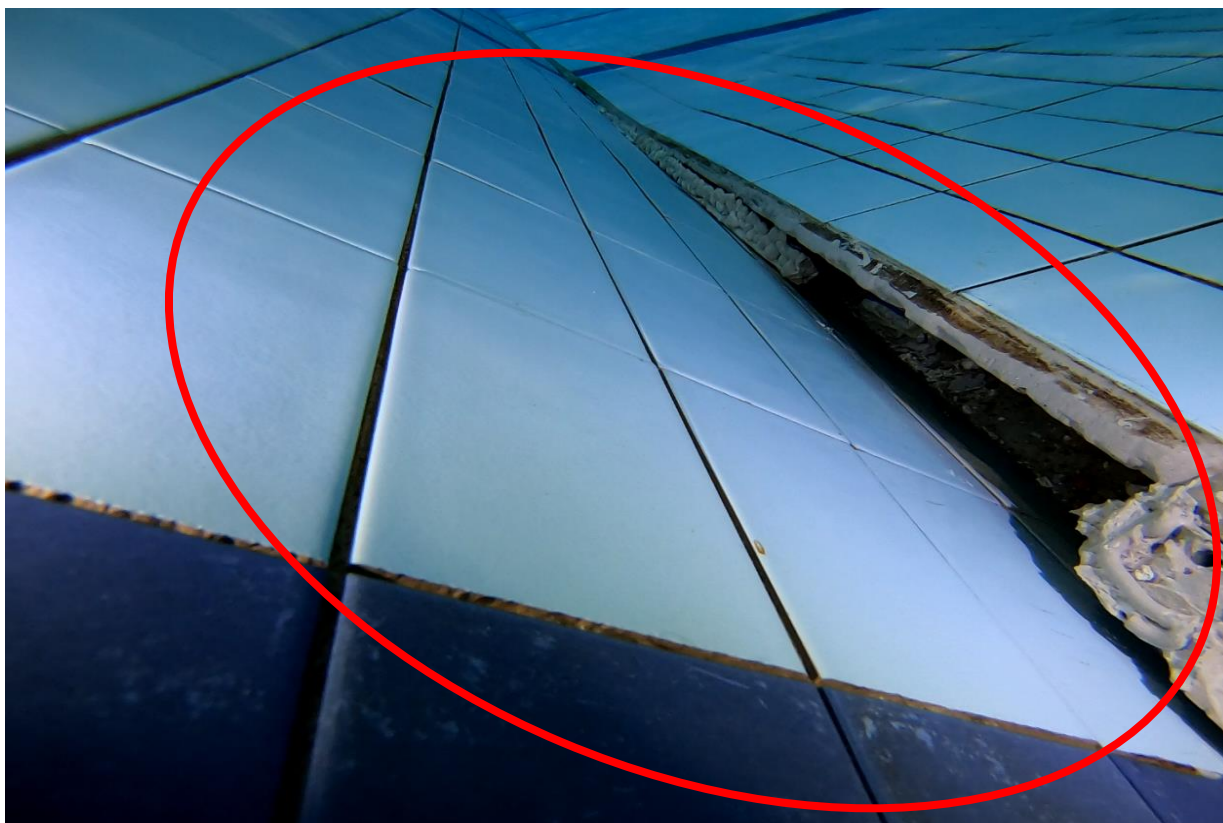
Detailní pohled na vzdutí dna plaveckého 50m bazénu a poškození dlažby, hydroizolace a konstrukce mazaniny.
